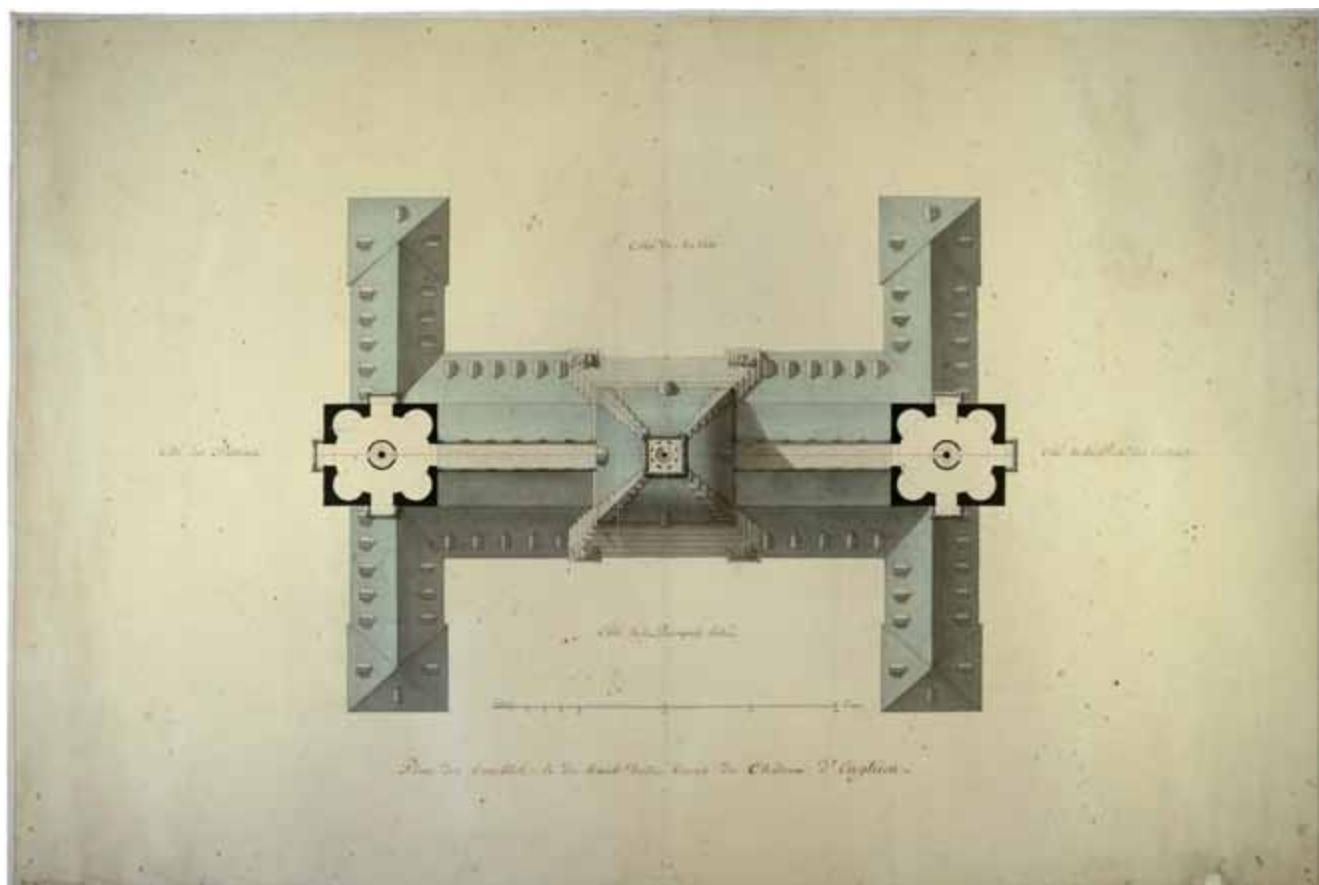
Plan de la toiture du château projeté (Archives Générales du Royaume).
